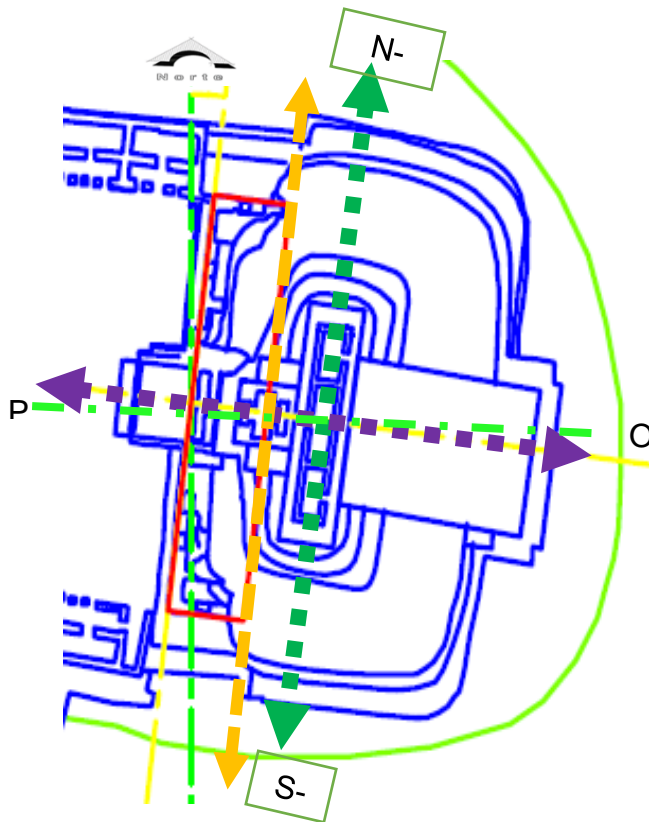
Cortés Juan. Planta arquitectónica del Edificio del Adivino mostrando los ejes de transmisión de cargas y como estos trabajan como contención y como contrafuertes. Plantas Arquitectónicas. 2013. Acervo J. Cortés.
